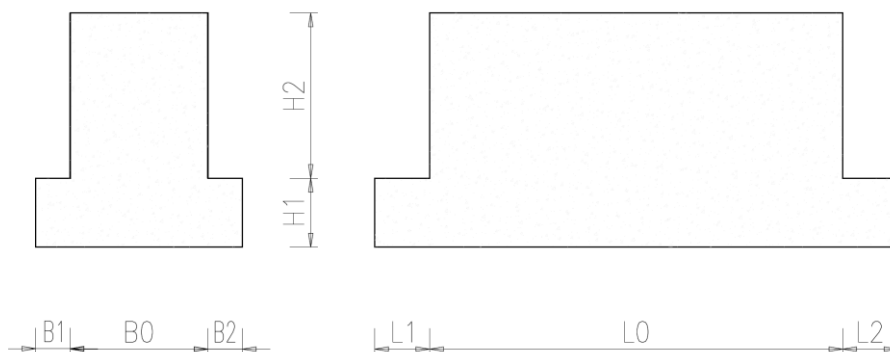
SCHEMA STRUTTURE DI FONDAZIONE
